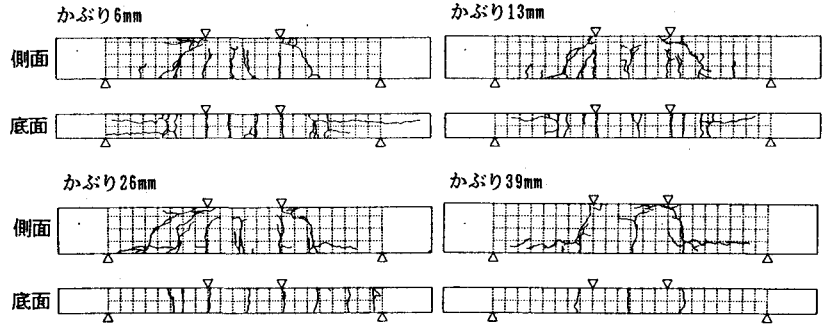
アラミド繊維を用いたはりのひび割れ発生状況
